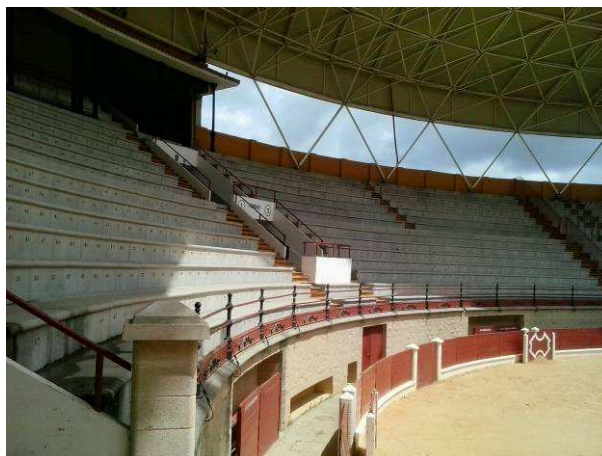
Vista interior de la plaza. Zona de presidencia
